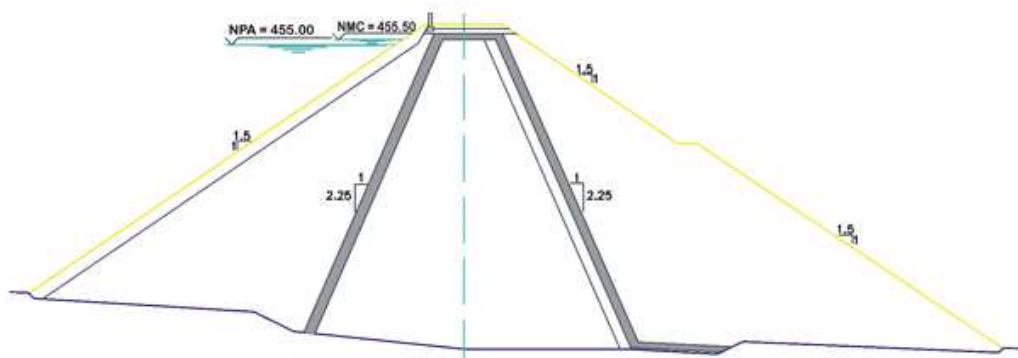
Perfil transversal tipo da barragem de Rego do Milho.
